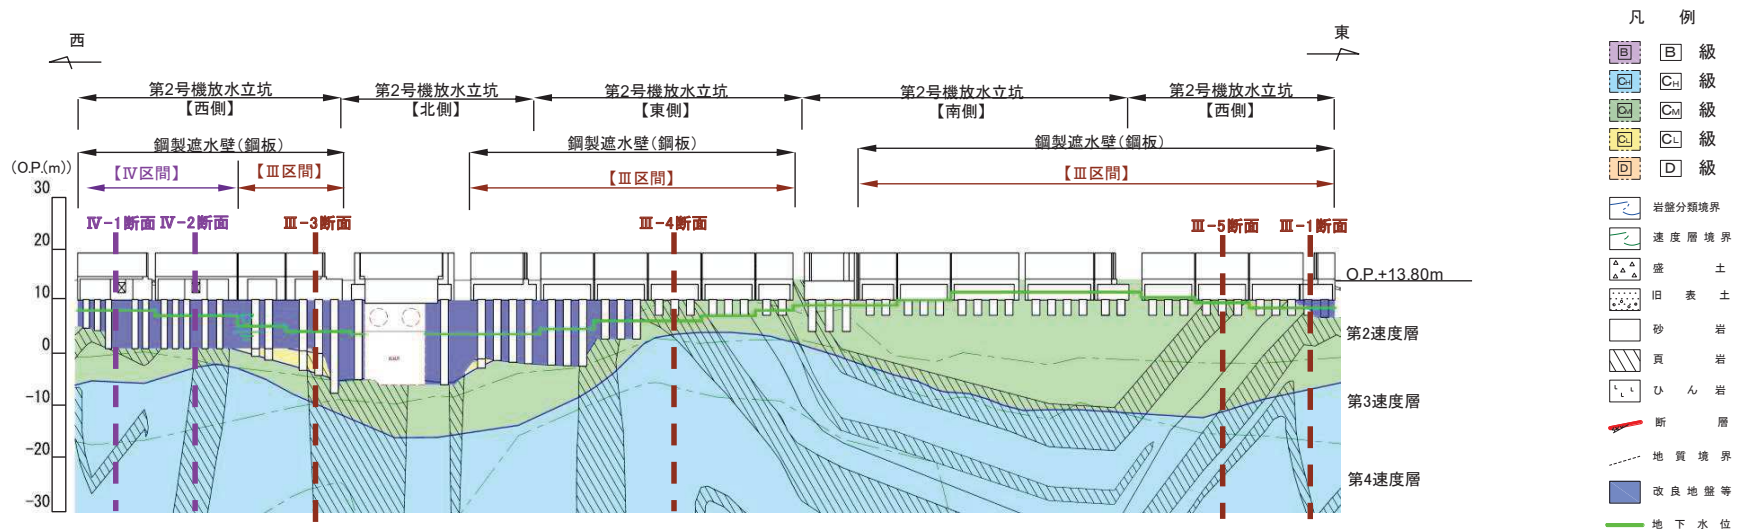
(2) 評価候補断面の地質縦断図 (第2号機放水立坑)
